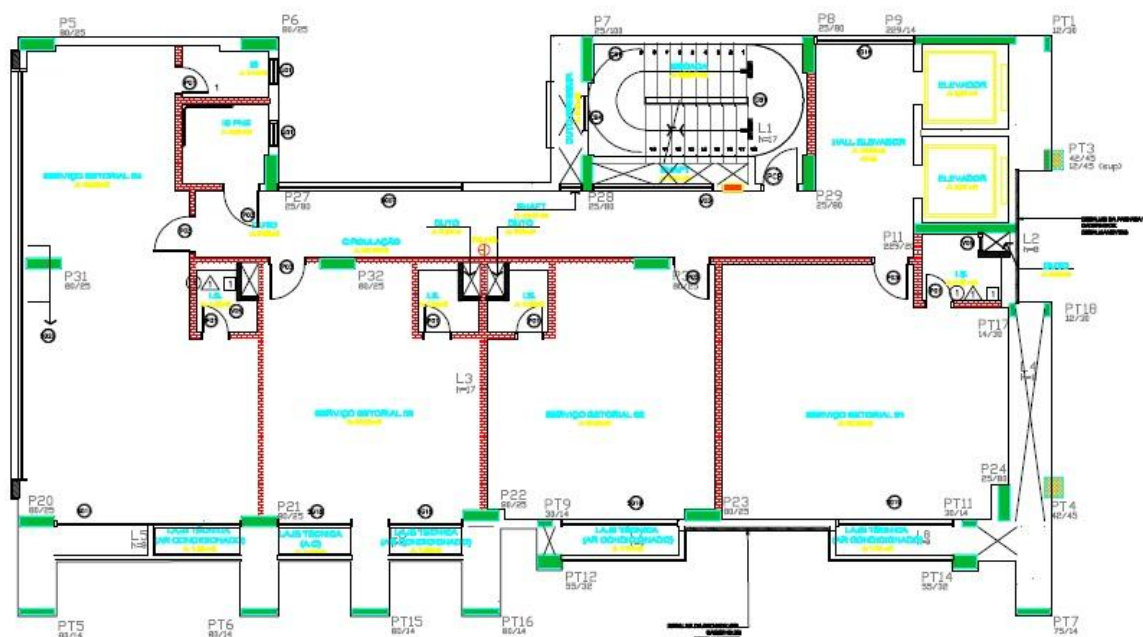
Croqui dos pavimentos 7 e 8 com demarcação de áreas de estudo (vermelho)
